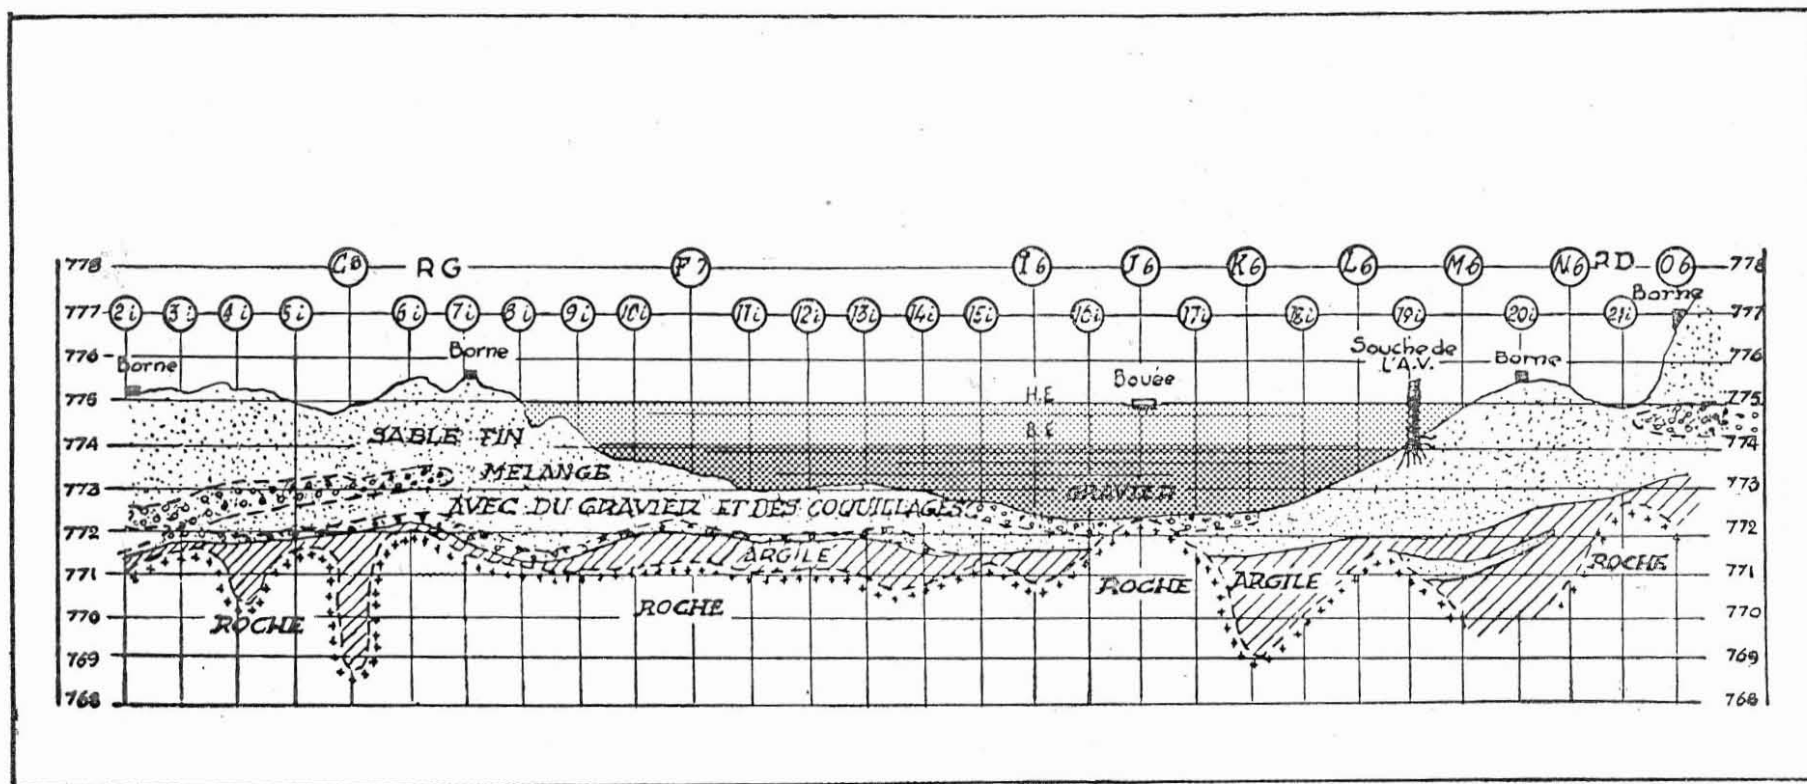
Coupe du terrain à l'emplacement I du barrage de la Lukuga (Traverse 6 : voir planche II).
